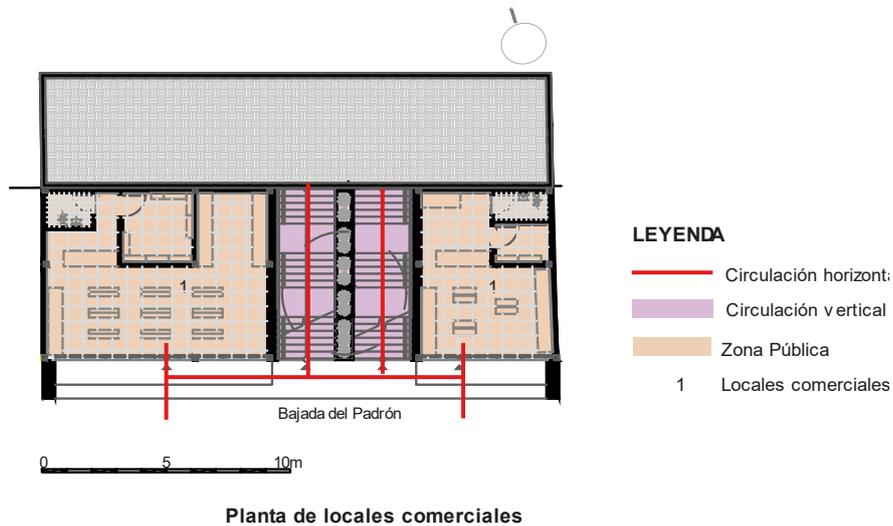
Distribución de planta de comercios de la calle Bajada del Padrón
